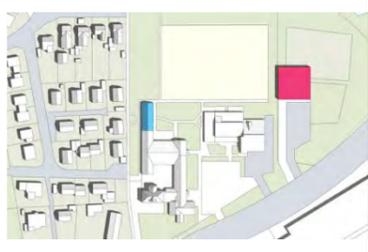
Variante 5 - Grundriss "Dorfhalle"
